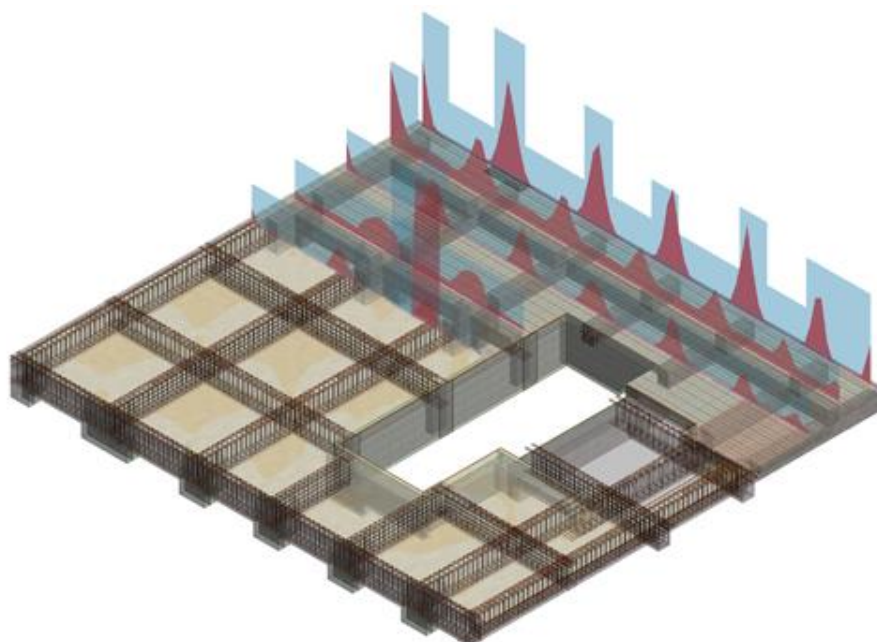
Automatisch generierte Bewehrung unter Berücksichtigung der erforderlichen Bewehrung [34]
